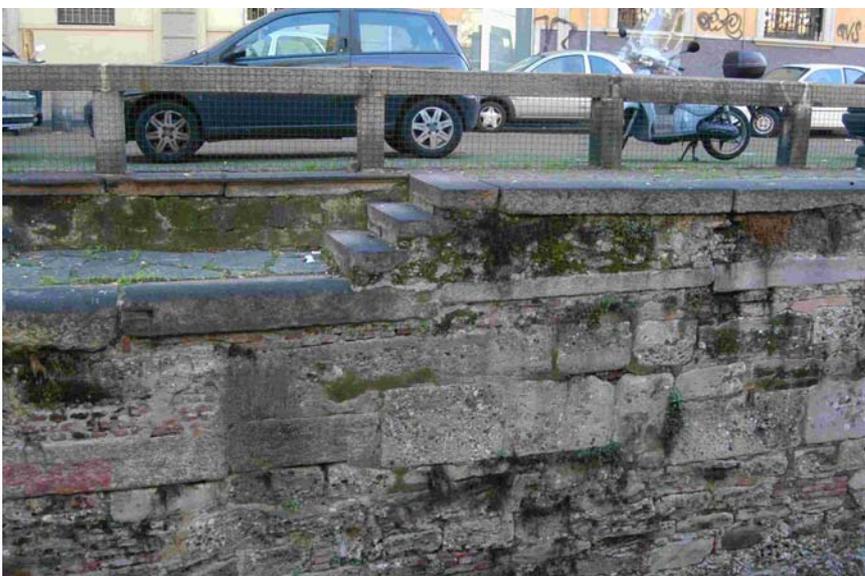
Particolare del muro della sponda sinistra sopralzata con scaletta di risalita
